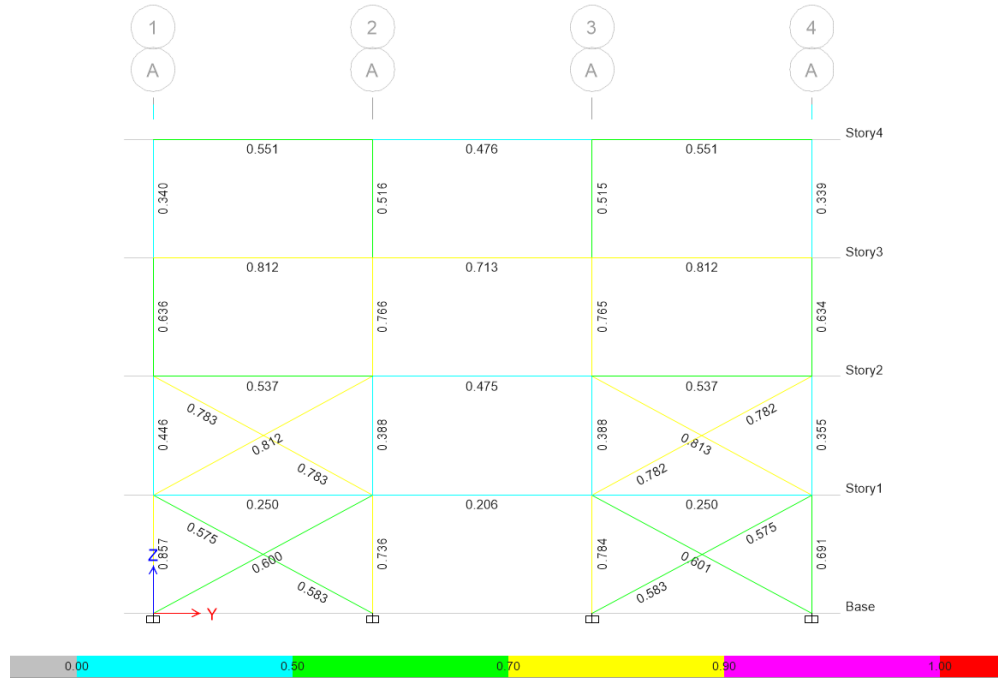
Trabajo de los elementos estructurales sobre eje A, estructura con base fija.
